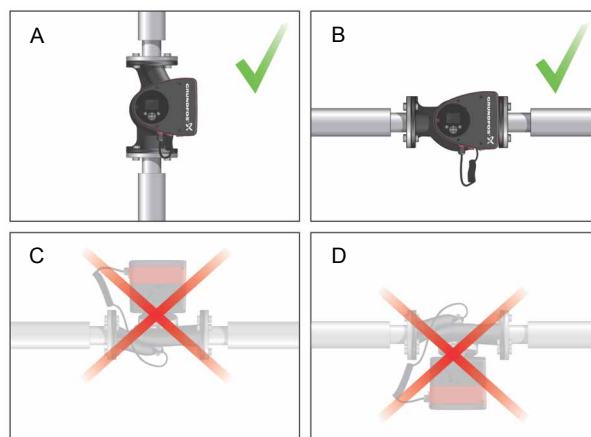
Pumpe mit horizontal ausgerichteter Motorwelle
